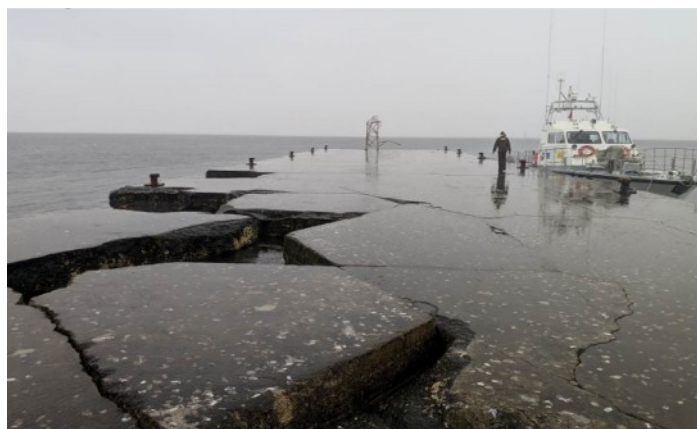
Estado de la losa del muelle de la Isla de Alborán.
